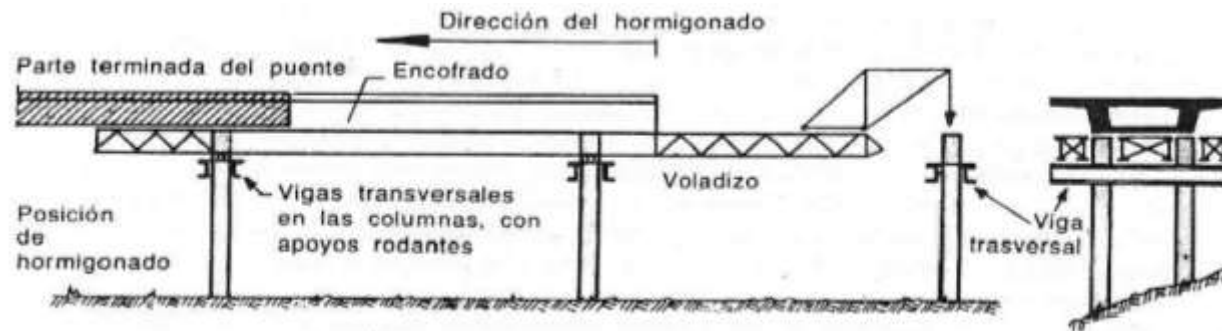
construcción por tramos con cimbra de avance móvil sobre rodillos colocados en vigas transversales fijadas en las columnas.
